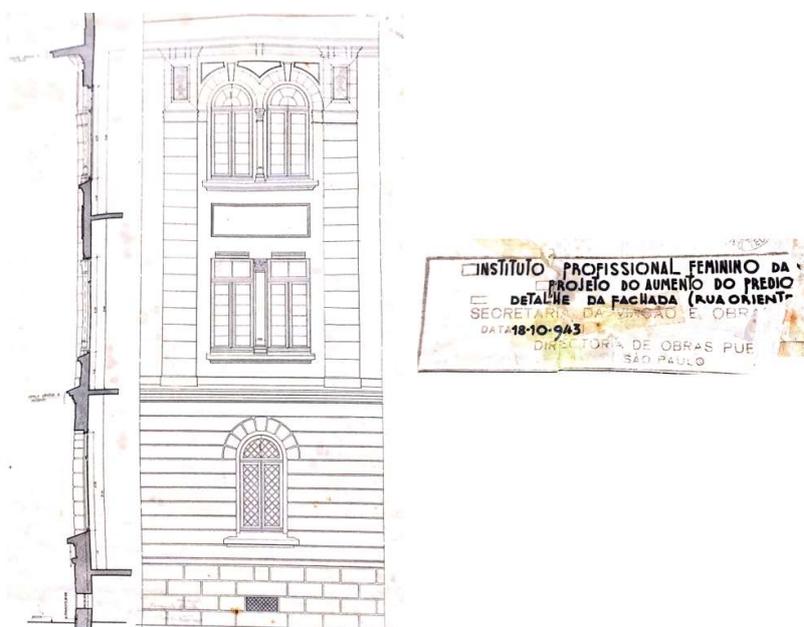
Planta de 1943 com aumento de área e fachada para a Rua Oriente
